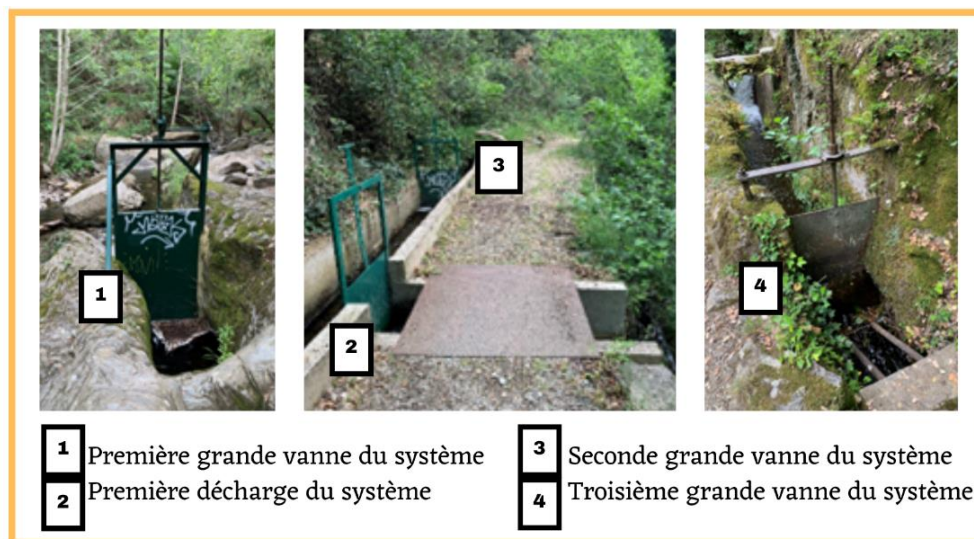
Photographie des premiers ouvrages de gestion hydraulique aux Pierres Plates, auteure 2023.
